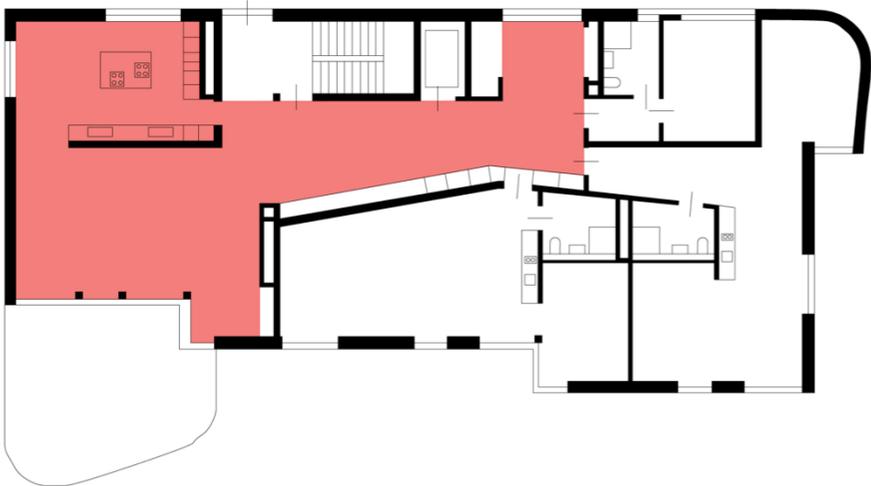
Kanzleiseen, Grundriss Clusterwohnung
